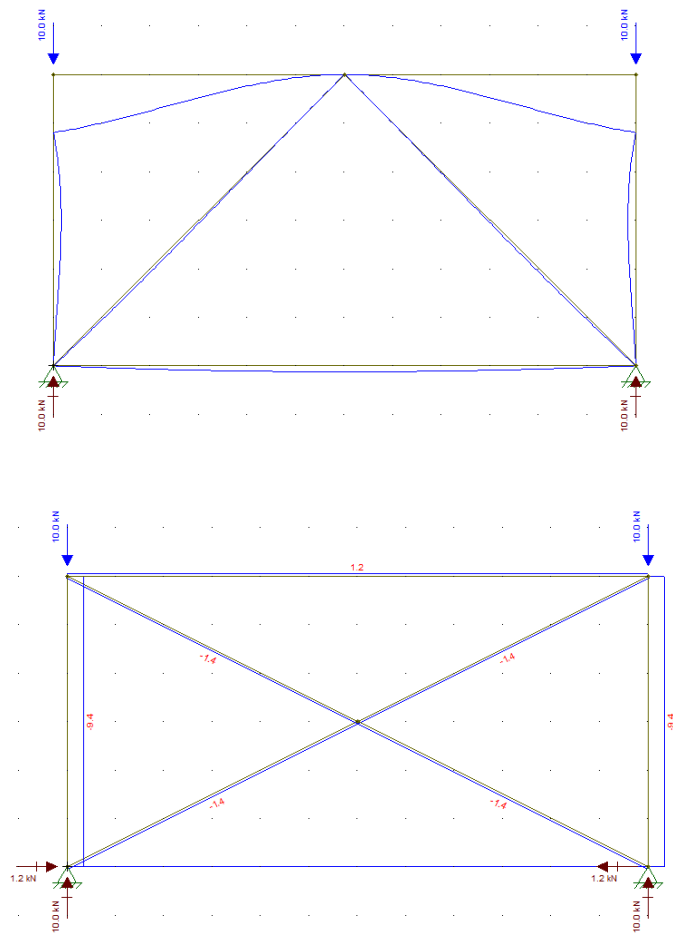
Efeito de carregamentos verticais em pórticos contraventados
